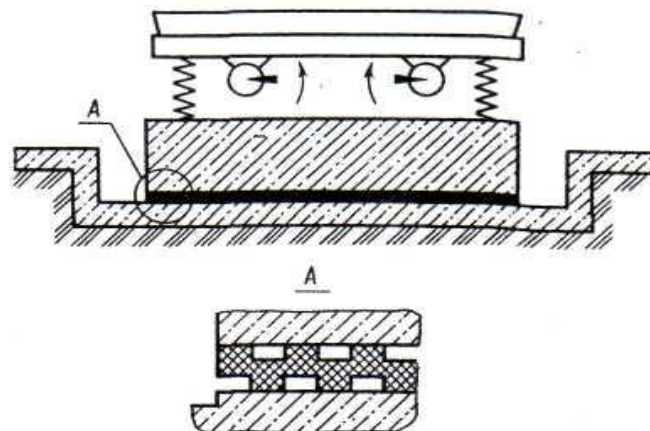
Схема установки коврика КВ-2 под фундамент виброплощадки
